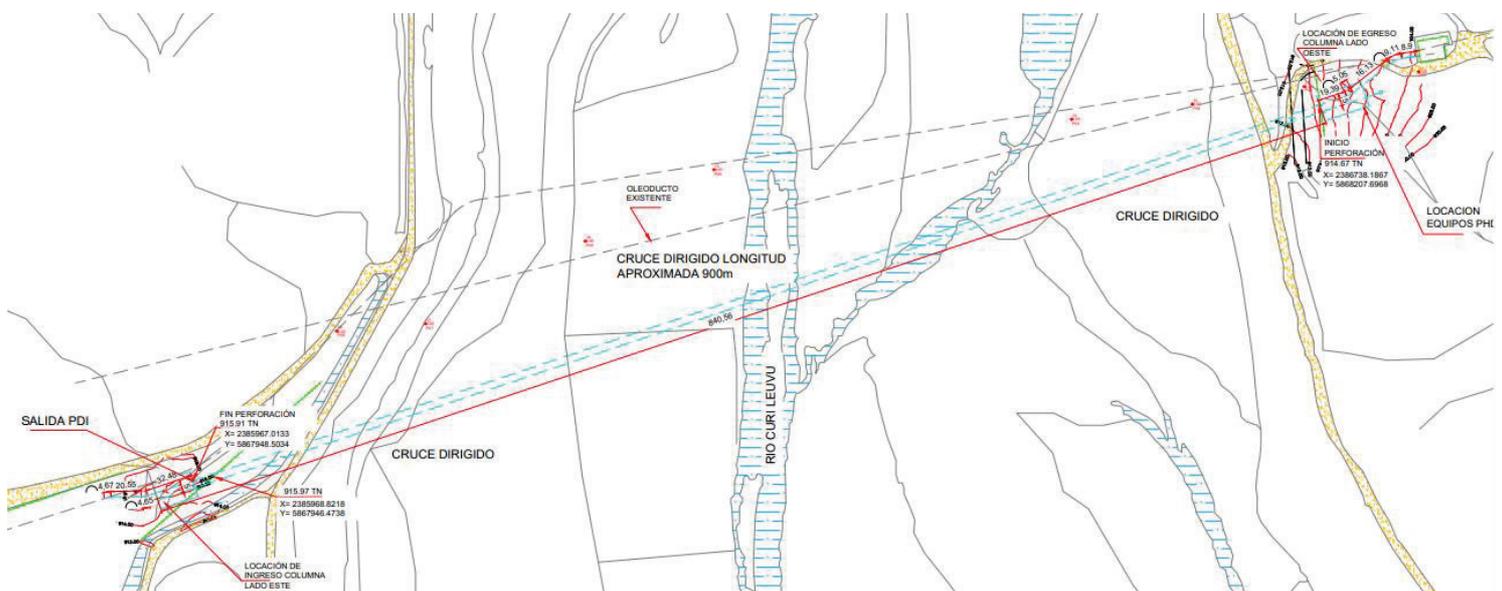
Traza de cruce en planta. Locación de ingreso y egreso de columna
